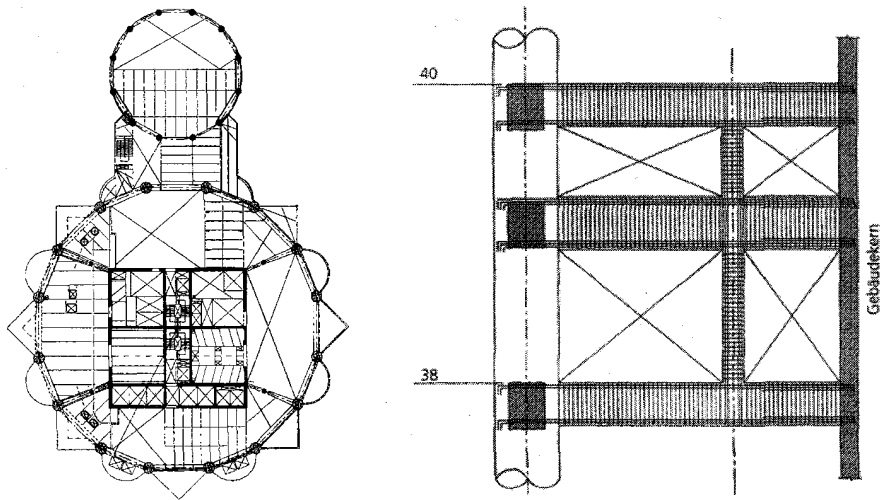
Grundriss und Ansicht der Ausleger im Bereich der Technikgeschosse [10.24]
